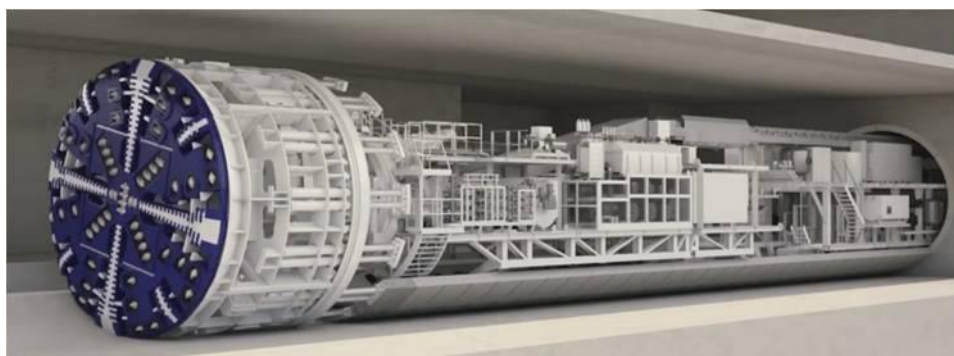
Traversée d'une gare par le tunnelier à l'aide de voussoirs inférieurs, source [4]
